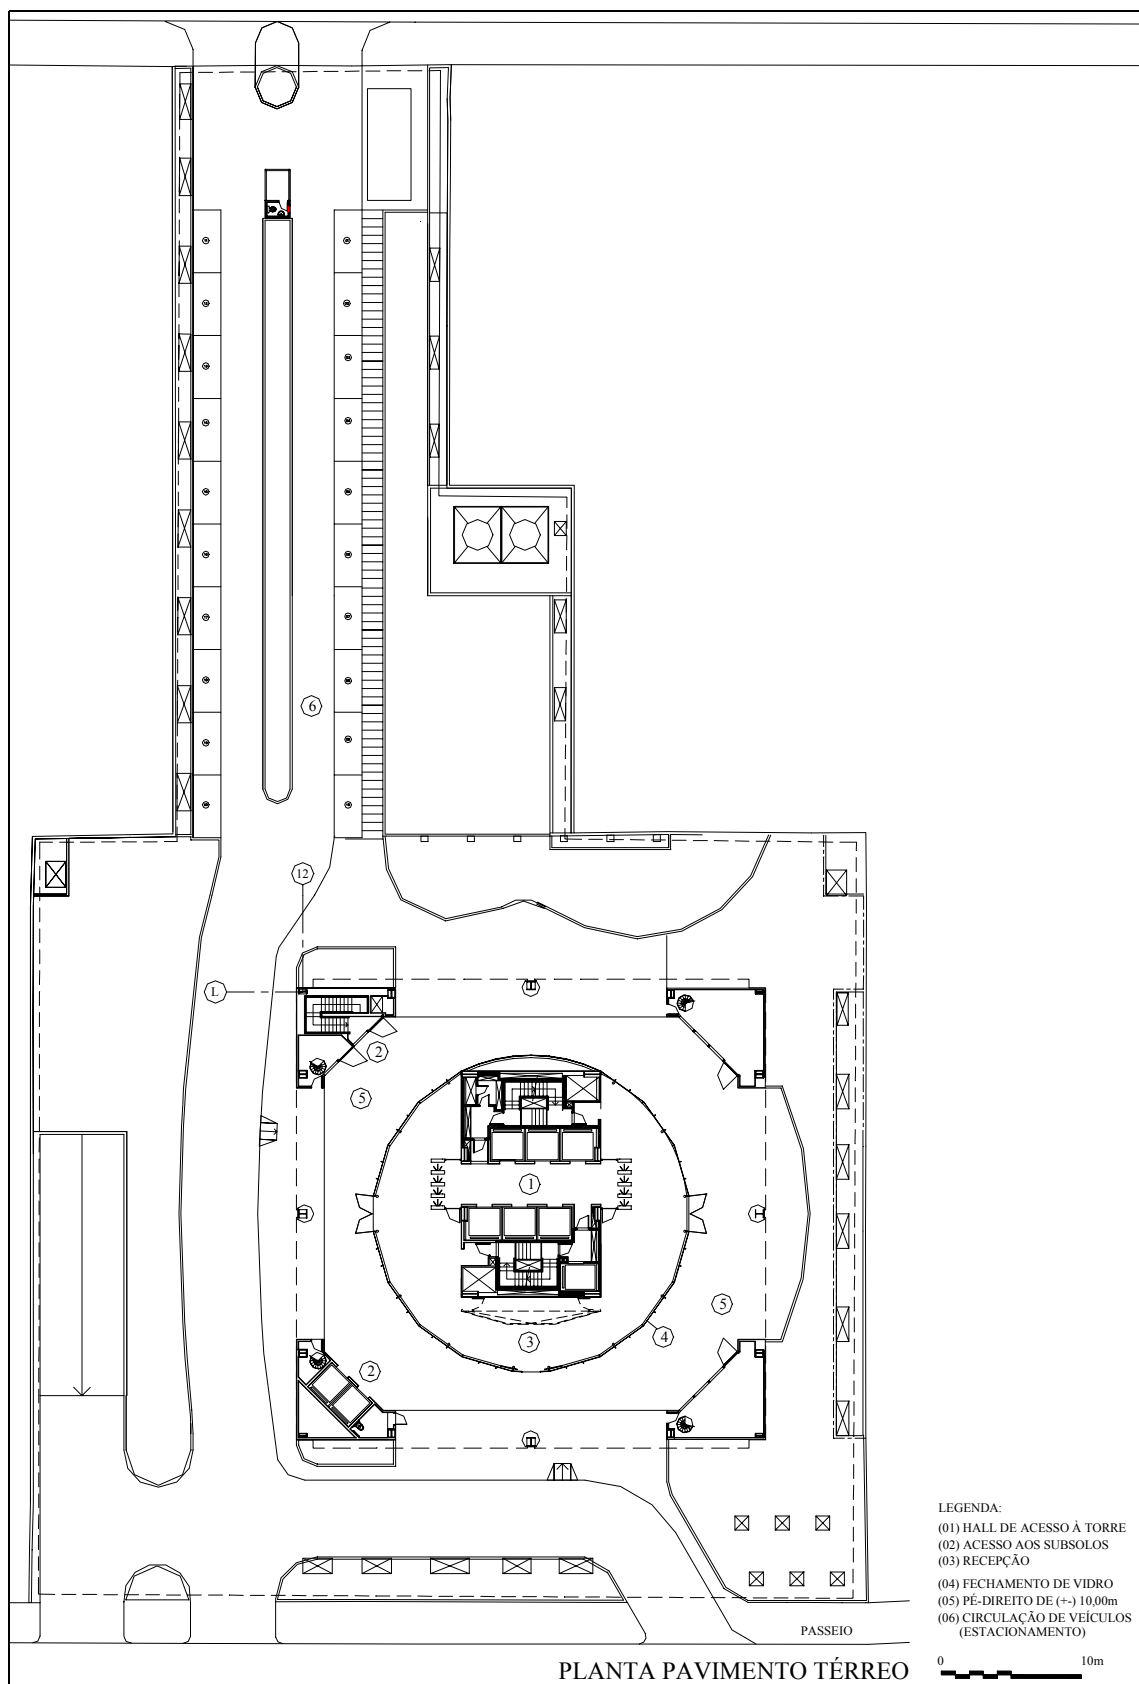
Solução arquitetônica do E-2: esboço da planta do pavimento térreo.
